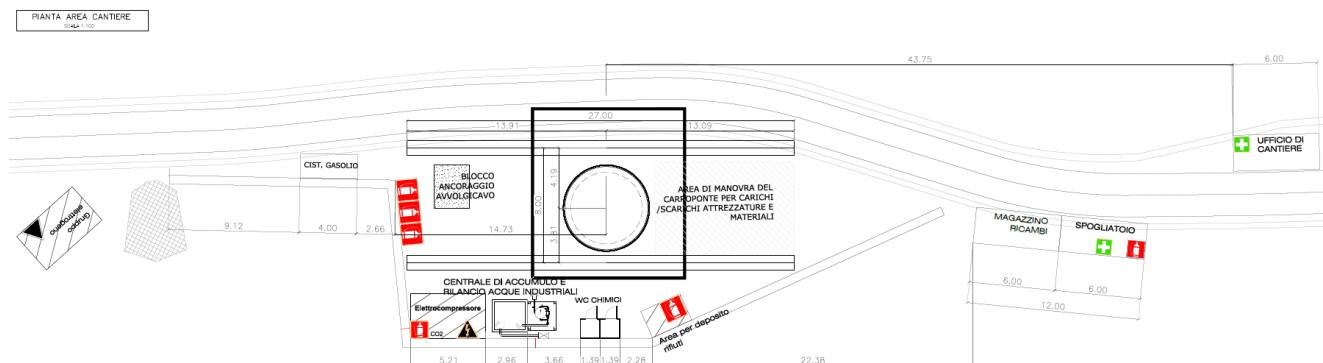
Cantiere pozzo: fase 2 – alesatura pozzo con scavo dall'alto
